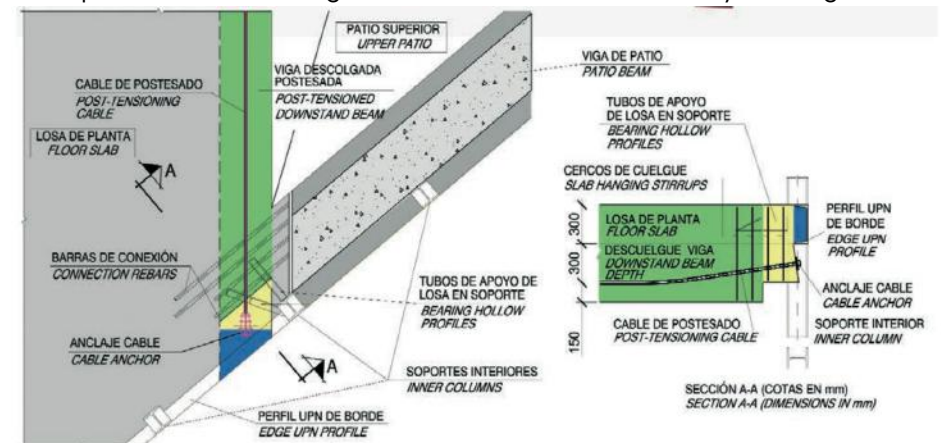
Detalle encuentro viga descolgada y viga de patio
